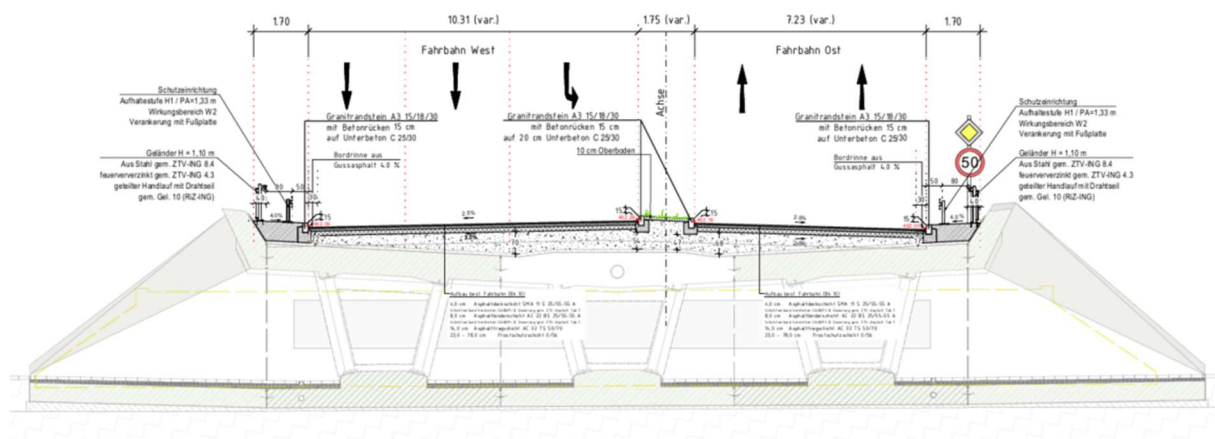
Ausschnitt Aufbau Fahrbahn
